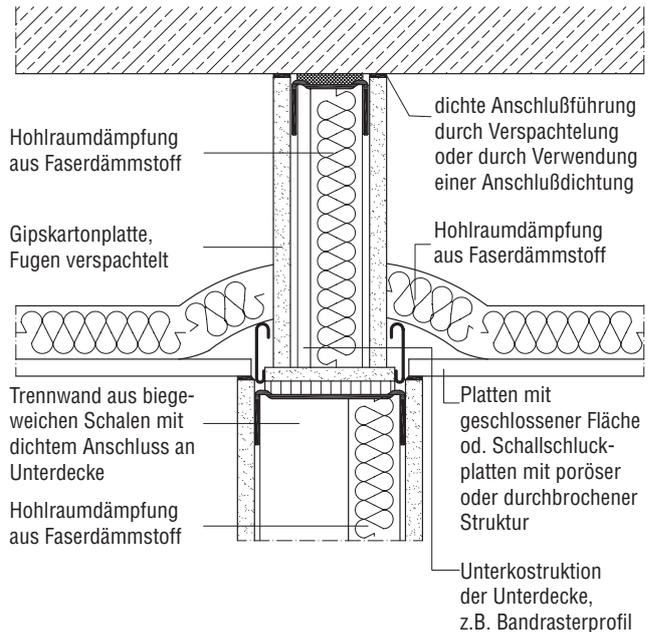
Trennwandanschluss an Massivdecke mit Trennung der Unterkonstruktion und der Decklage
